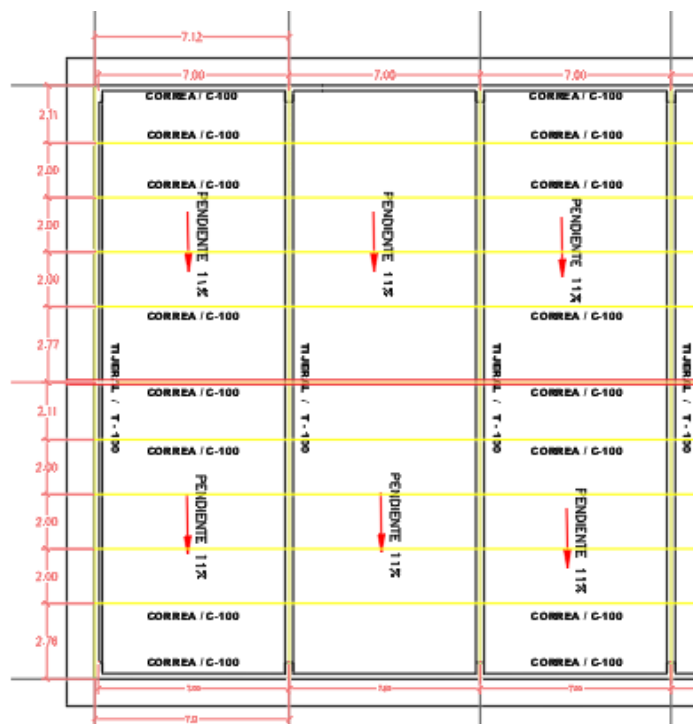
Diseño de cubierta para planta de procesamiento.
